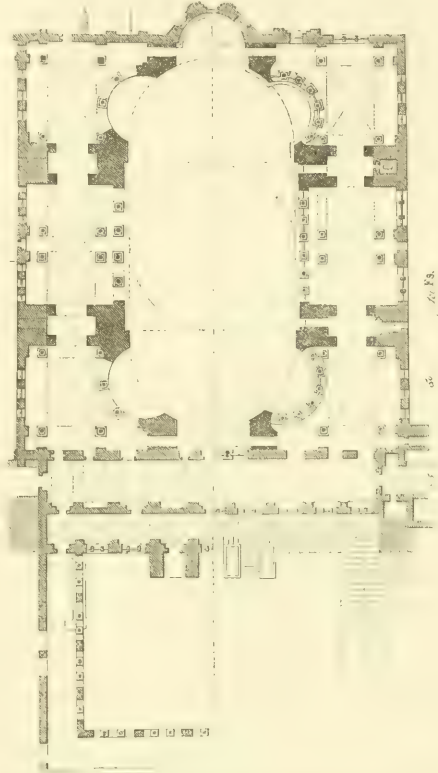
Grundriss der Sophienkirche in Constantinopel.
